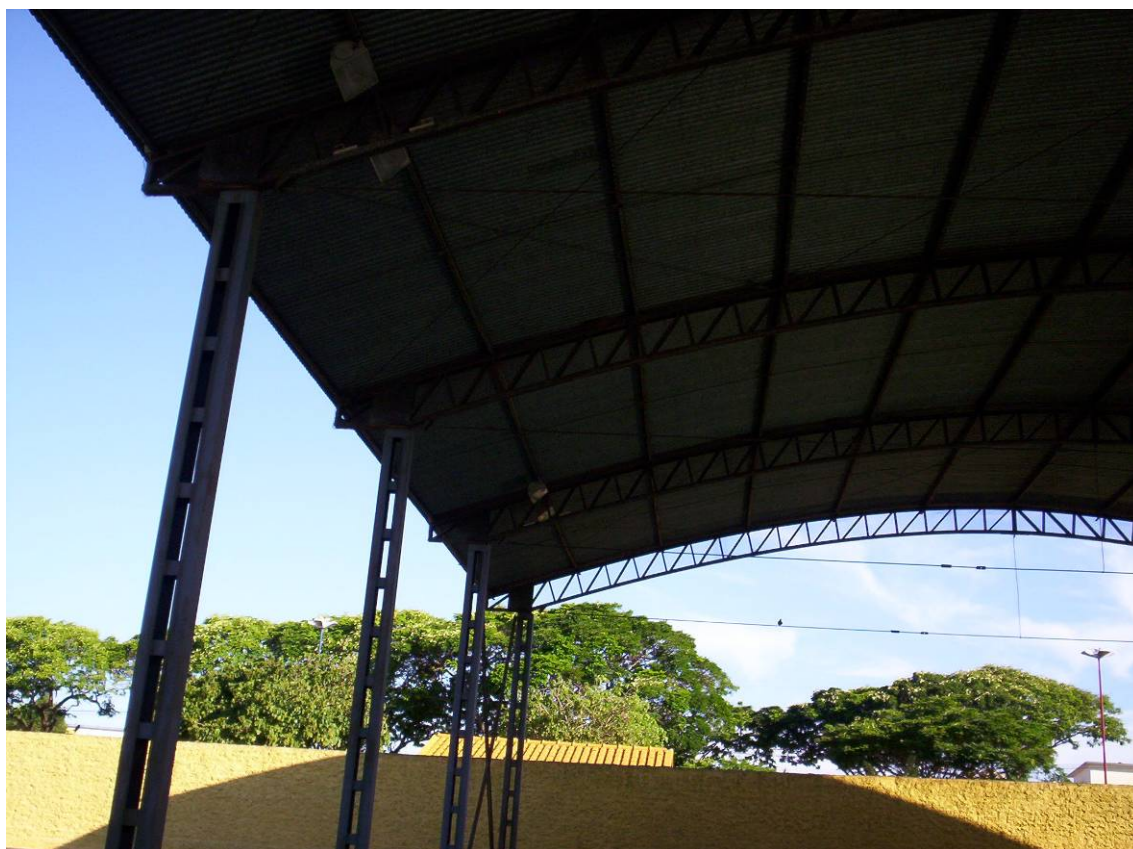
Na extremidade, existe um contraventamento vertical em X, mas não há uma barra horizontal de compressão unindo as cabeças dos pilares, o que compromete a estabilidade longitudinal da estrutura.
